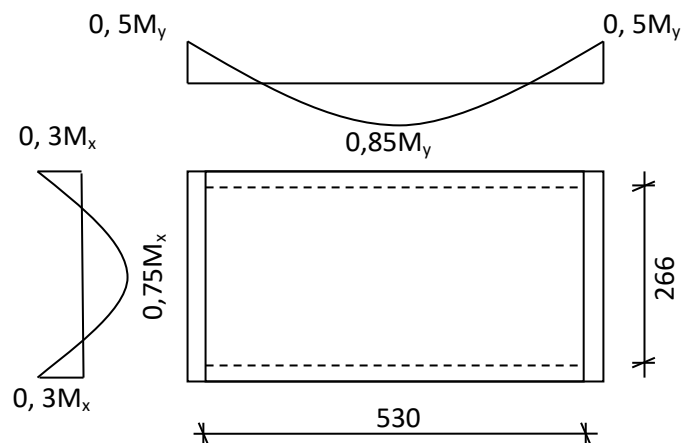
Panneau de dalle appuie sur 4 coté
